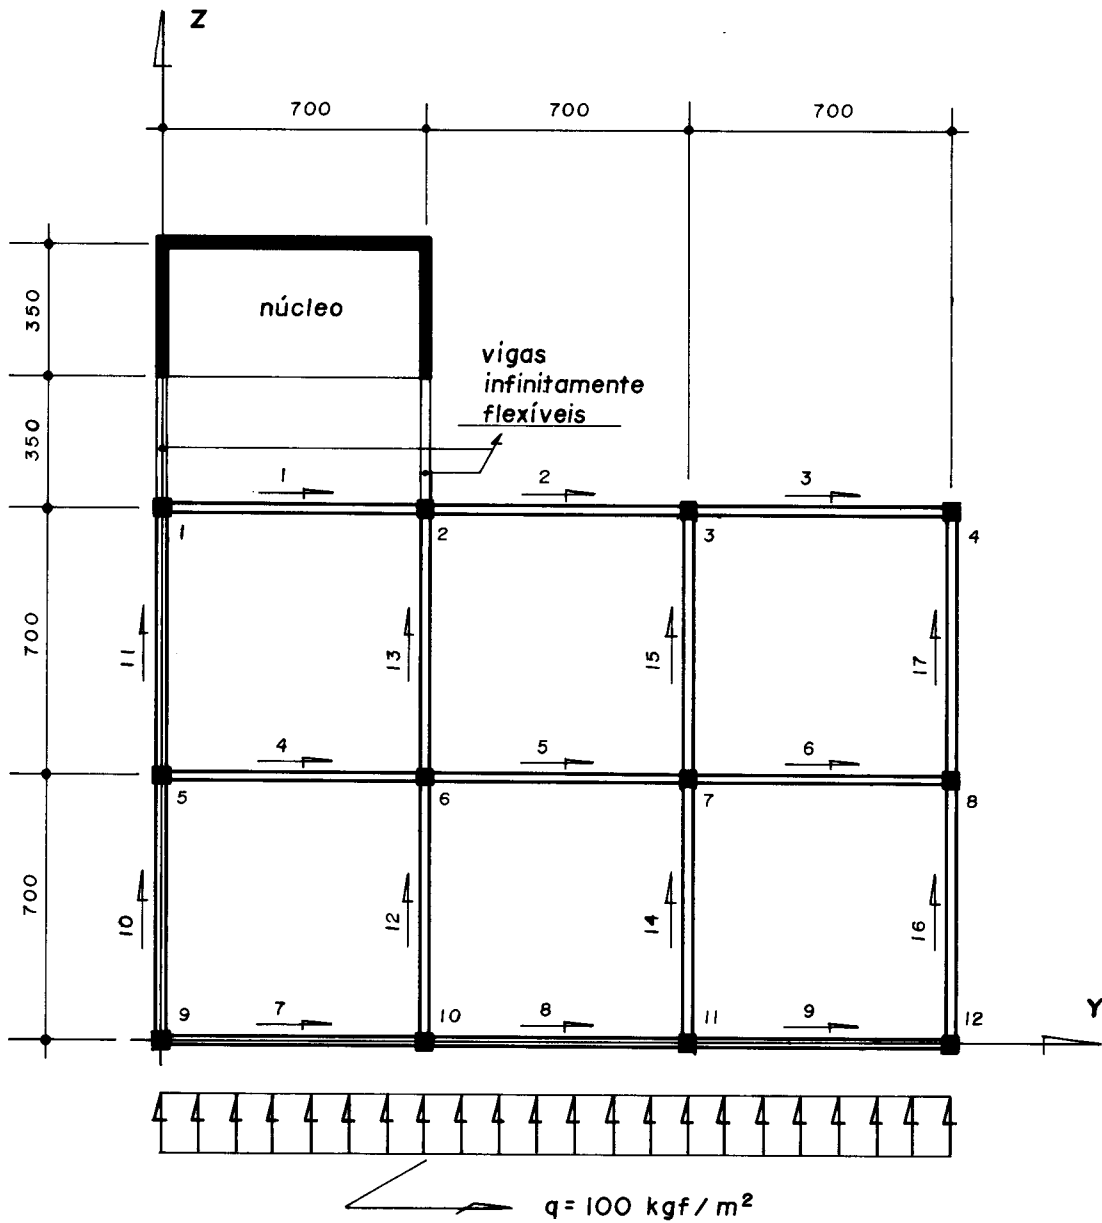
Exemplo nº 3 : estrutura (planta baixa) e carregamento atuante.
